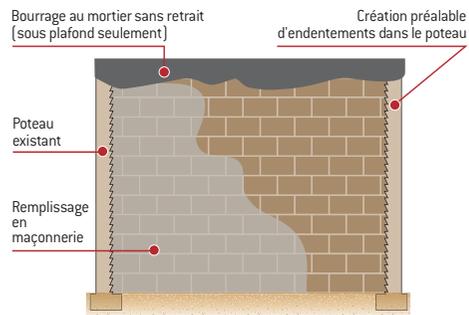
Création d'un mur en maçonnerie entre 2 poteaux existants (élévation)
